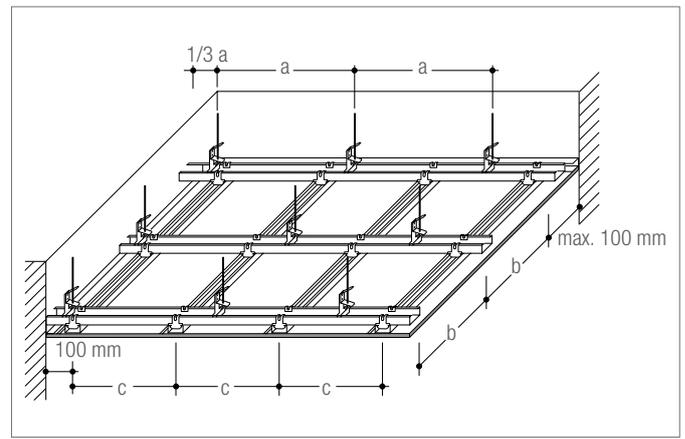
Abgehängte Metallunterkonstruktion nach DIN 18181
